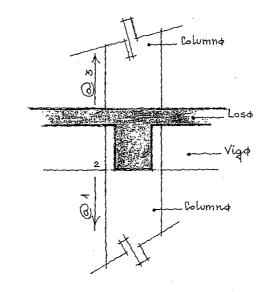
Columna (B), Nudo (2). Planta, (a).
